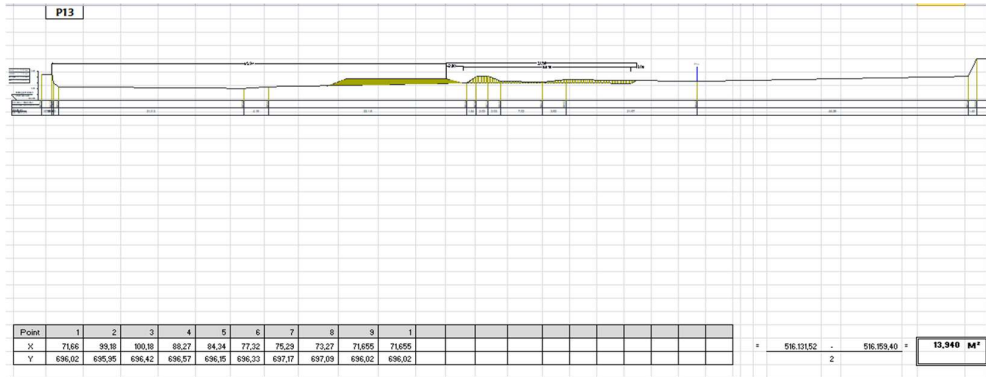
Potongan memanjang Sungai Ulu Masang
